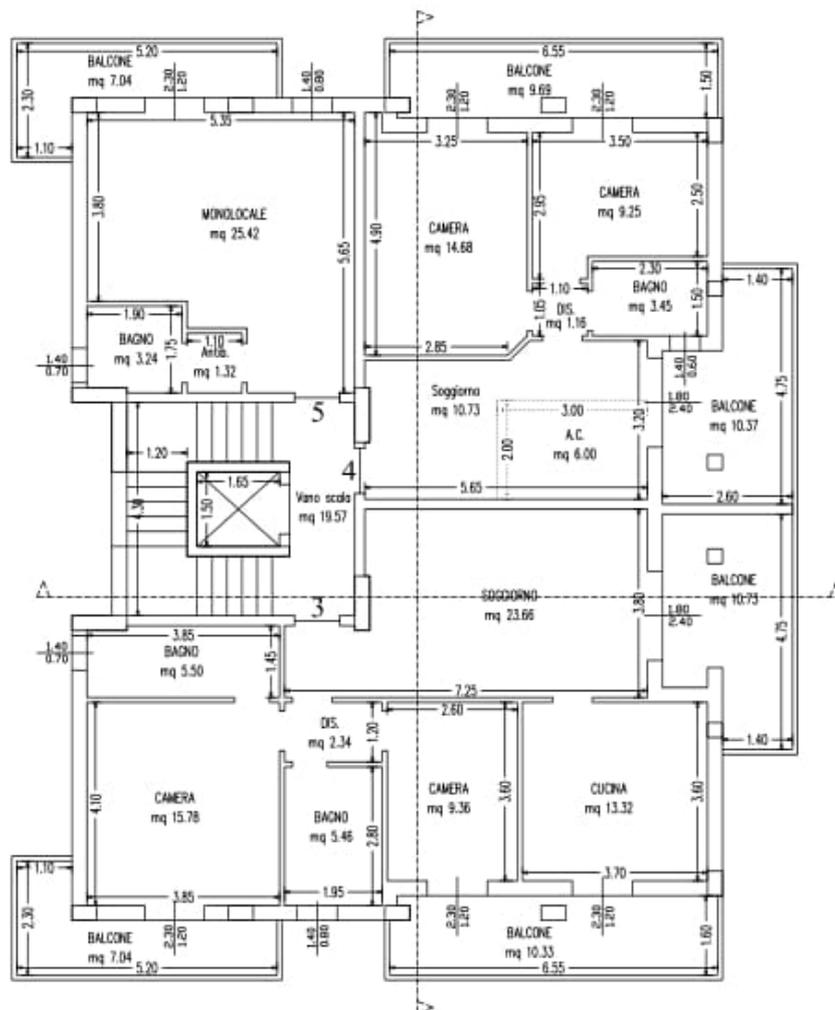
Pianta del secondo piano dell'edificio campione.
